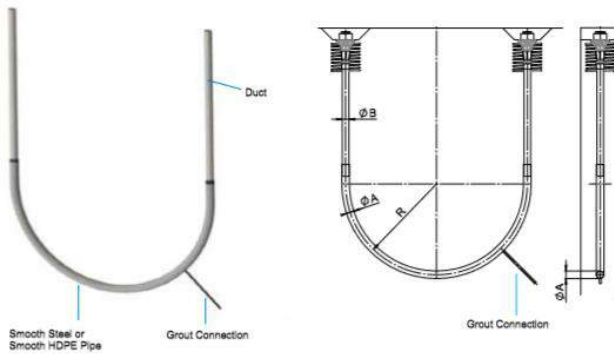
10. Detail *Stirrup Reinforcement* Tipe GC
